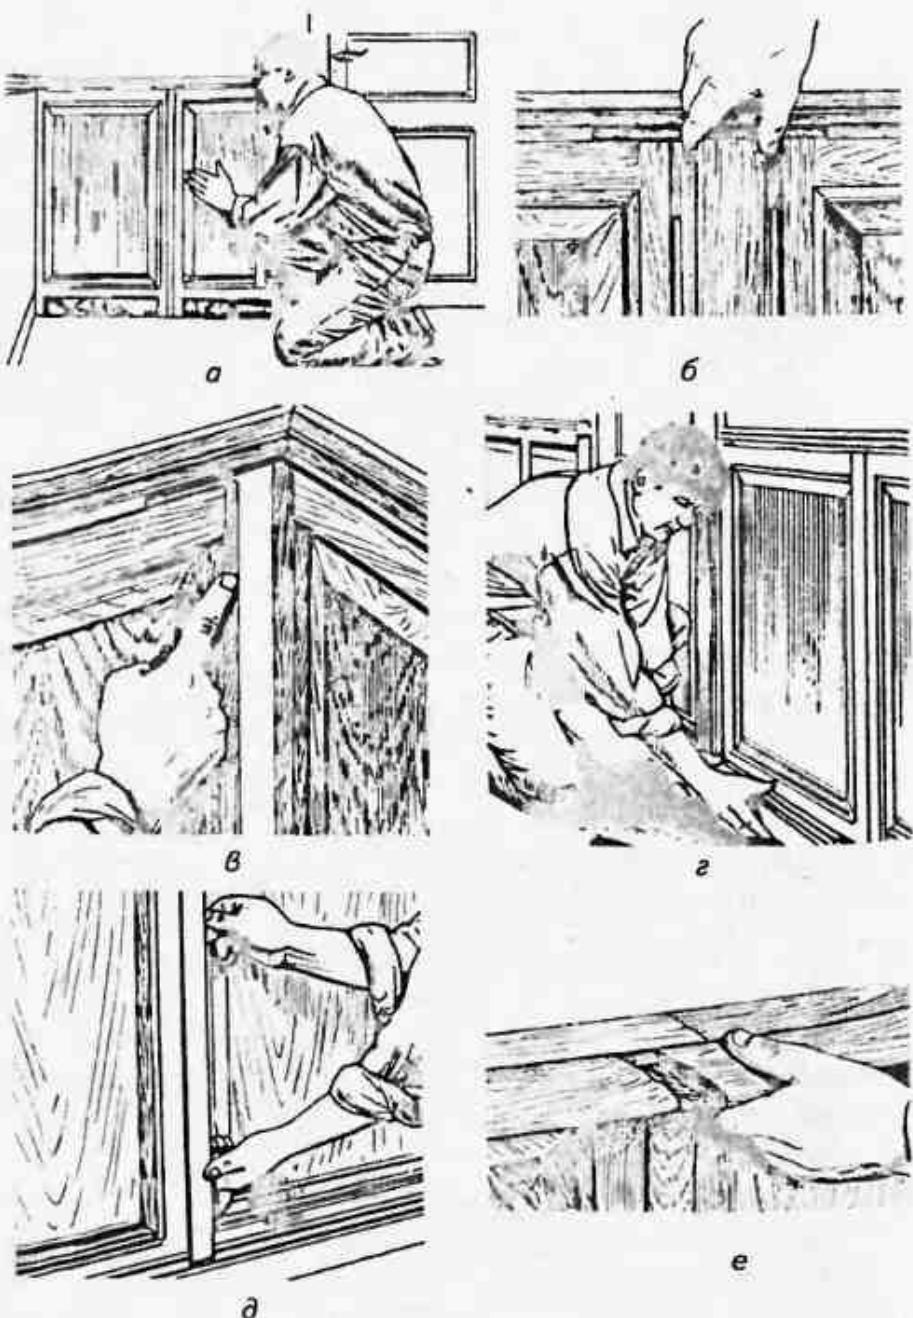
Монтаж филенчатых панелей: а — установка панелей; б — установка наращаивающих накладок; в — оформление внутренних углов; г — установка плинтуса; д — закрытие стыков специальными планками; е — установка бордюра
